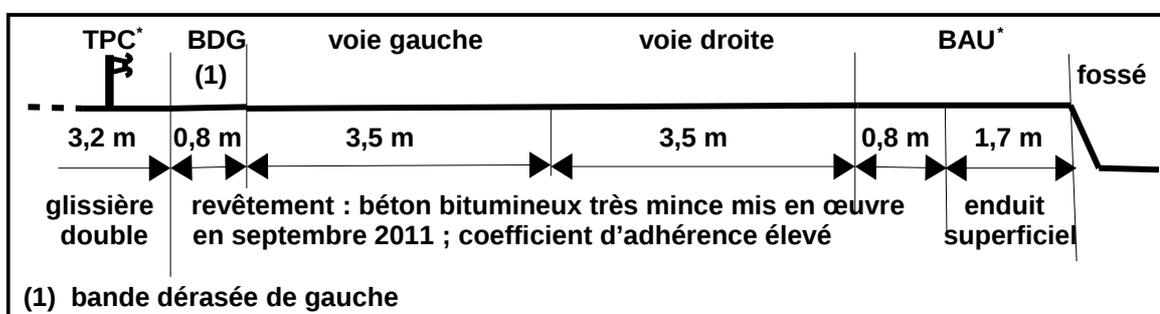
Demi-profil en travers de la RN 12 au niveau du PR 116,900
